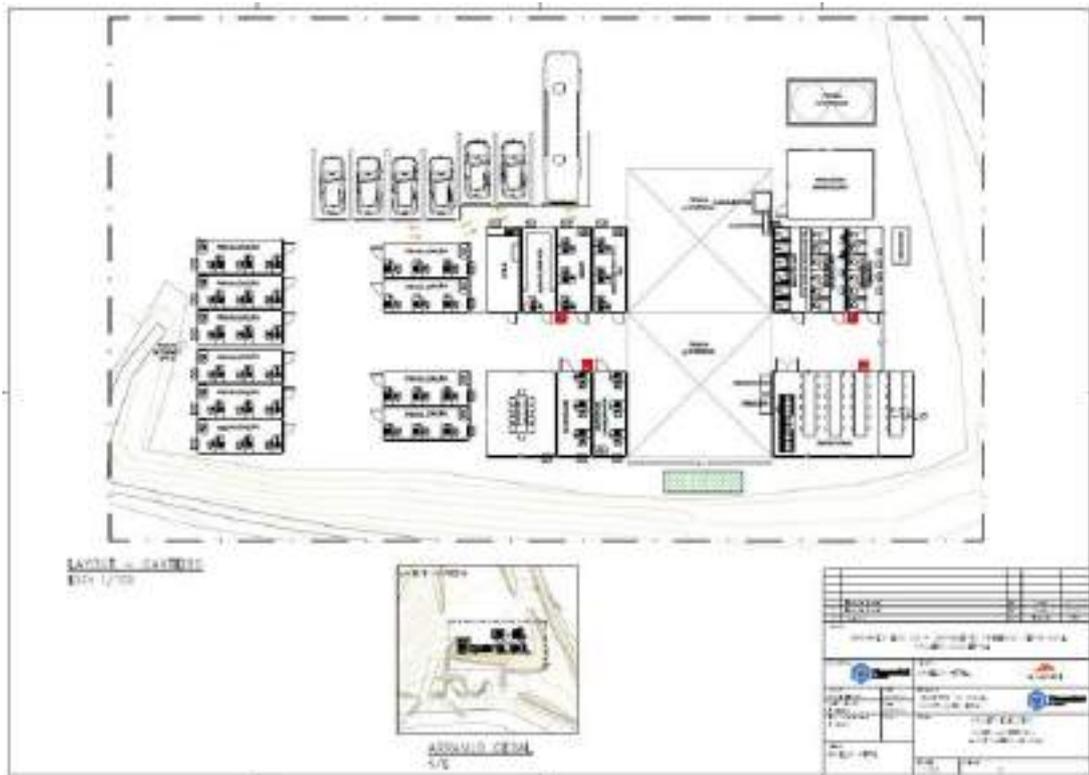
Layout Canteiro de obras administrativo – Contratada Piacentini.
